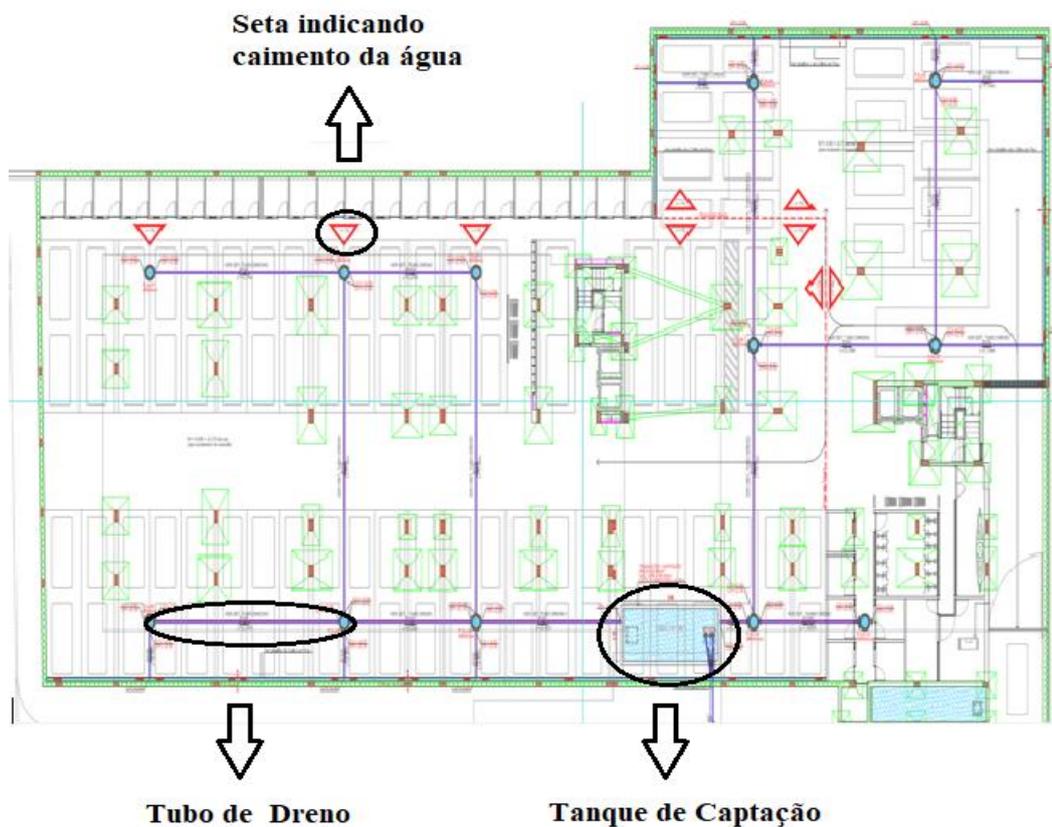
Projeto de drenagem de águas pluviais – planta baixa do subsolo
